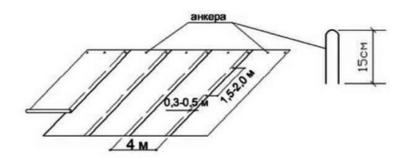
К грунту геотекстиль крепится с помощью анкеров
